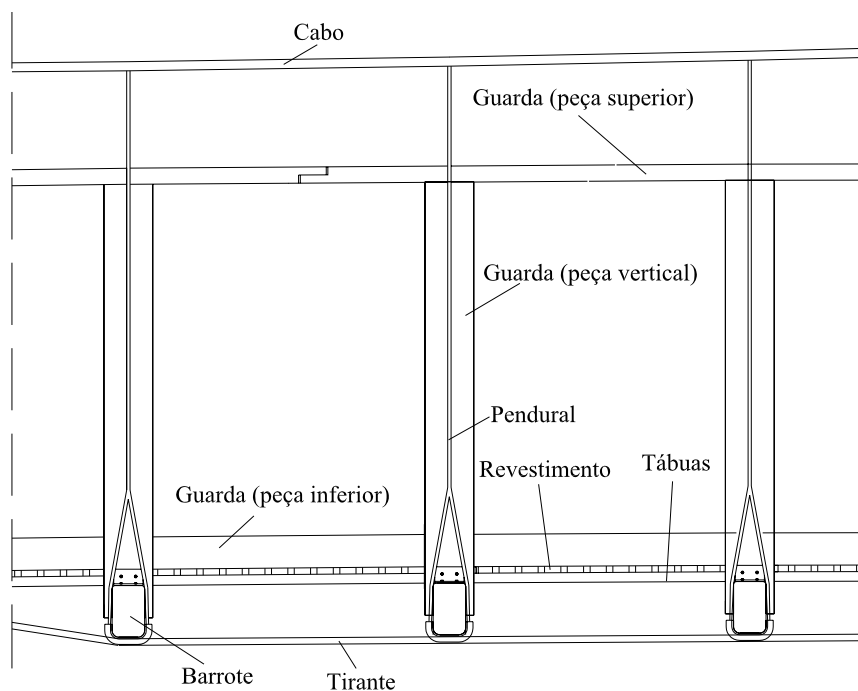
Vista em alçado da zona de passagem dos tirantes sob o pavimento.
